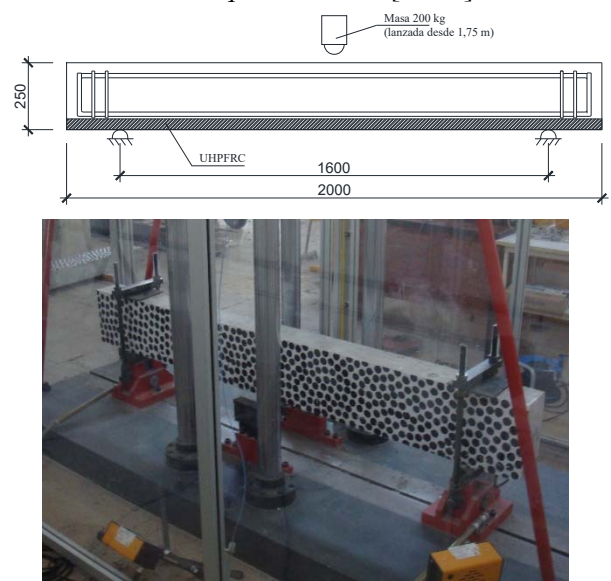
Configuración geométrica de las piezas ensayadas a impacto (dimensiones en mm) y fotografía de una viga dentro de la torre de caída.
